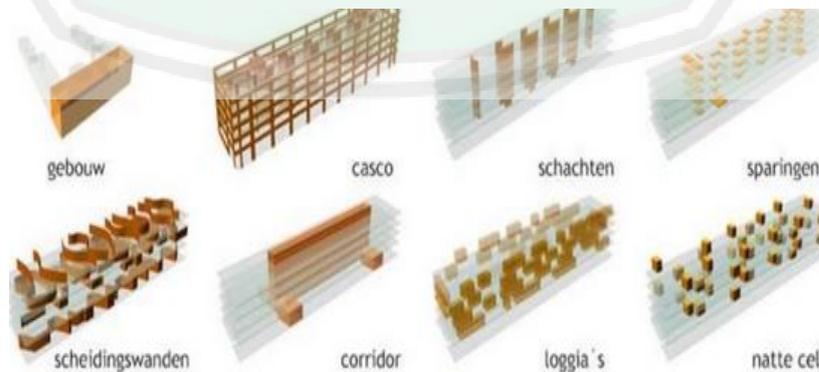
blok-blok bangunan multifunk (sumber:www.lingotto.nl)
